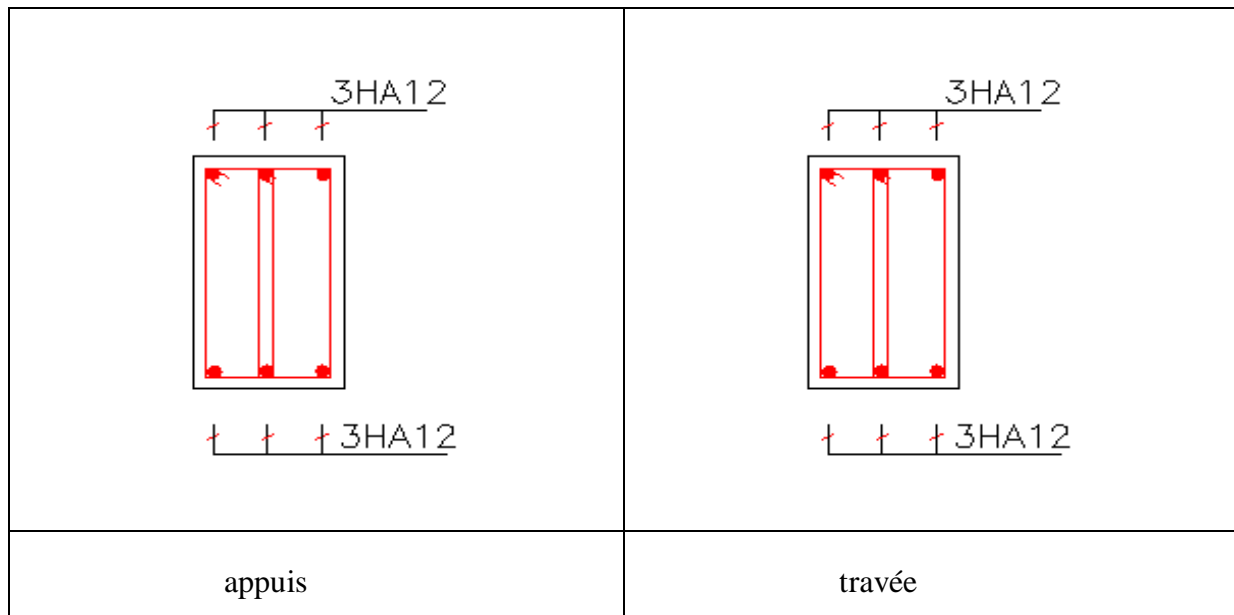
Schéma de ferrailage des poutres longitudinales
